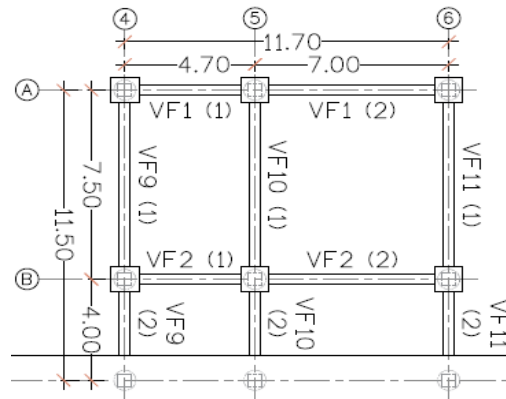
Planta de Identificação das Vigas de Fundação
